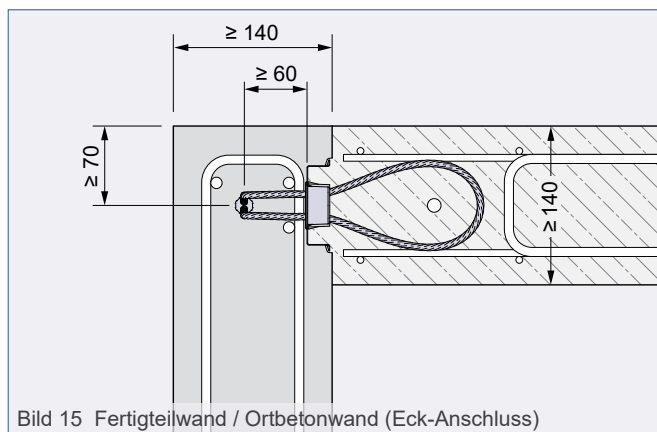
Fertigteilwand / Ortbetonwand (Eck-Anschluss)
